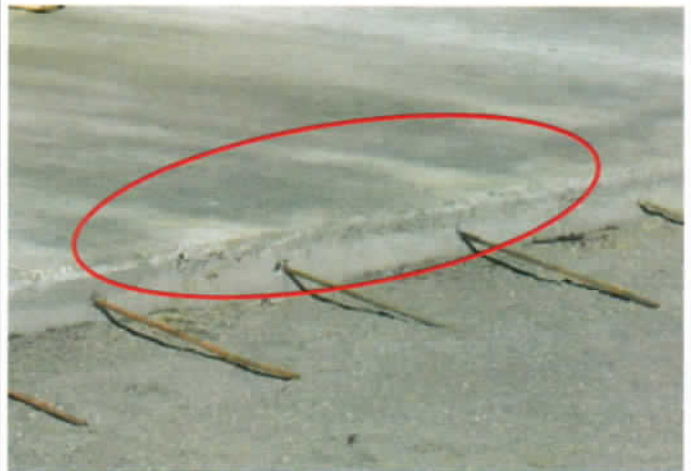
Fisura en el pavimento de la calzada, paño de la segunda franja poniente.
